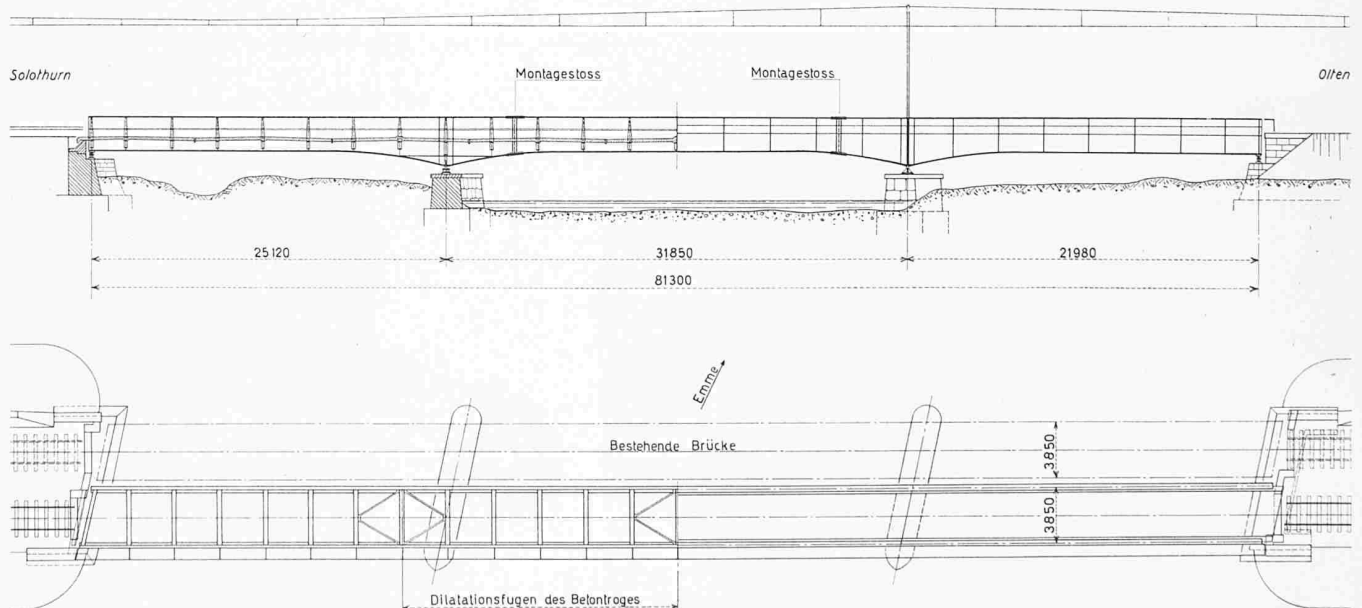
Grund- und Aufriss der Emmebrücke bei Luterbach, Masstab 1:500
